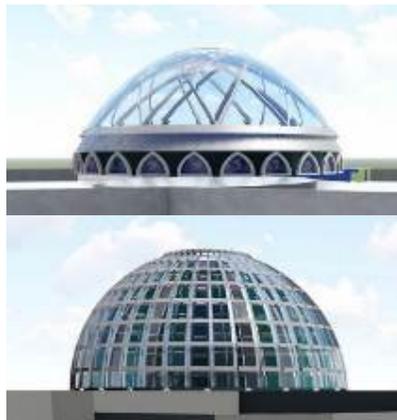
Penerapan struktur pada massa Bangunan *Guest House
